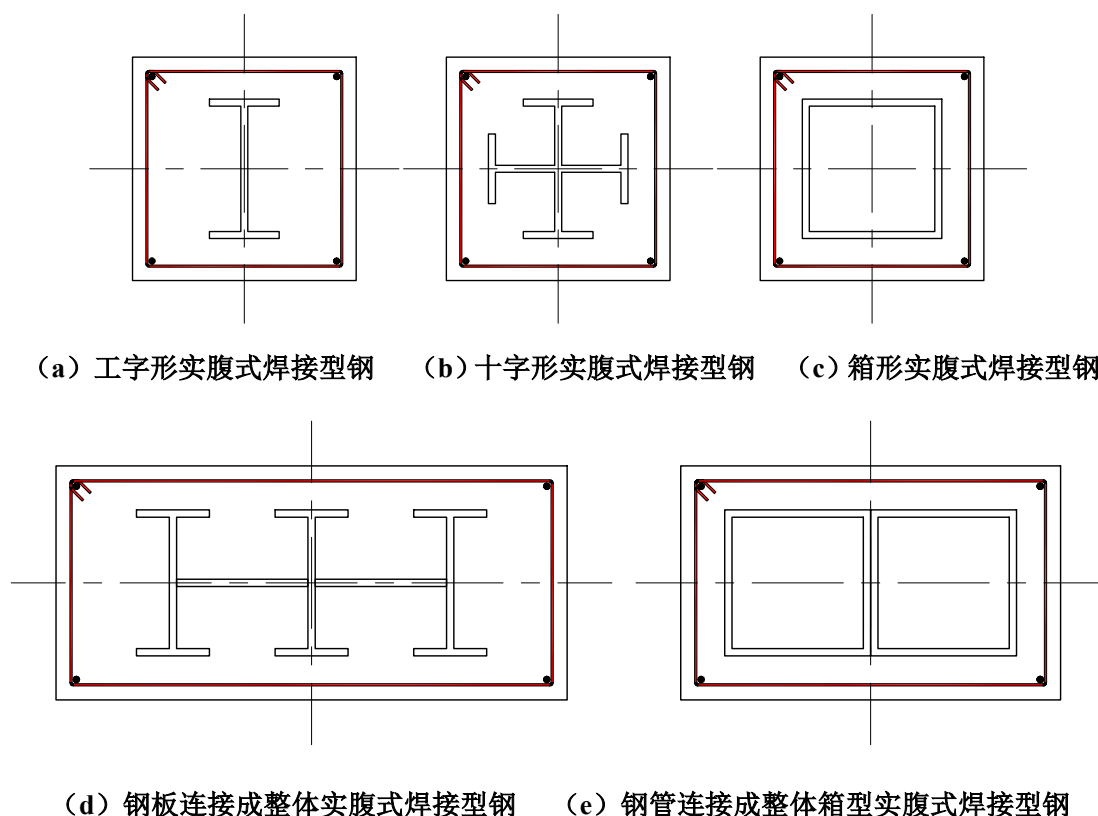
预制型钢混凝土柱内埋置的型钢截面配筋形式
